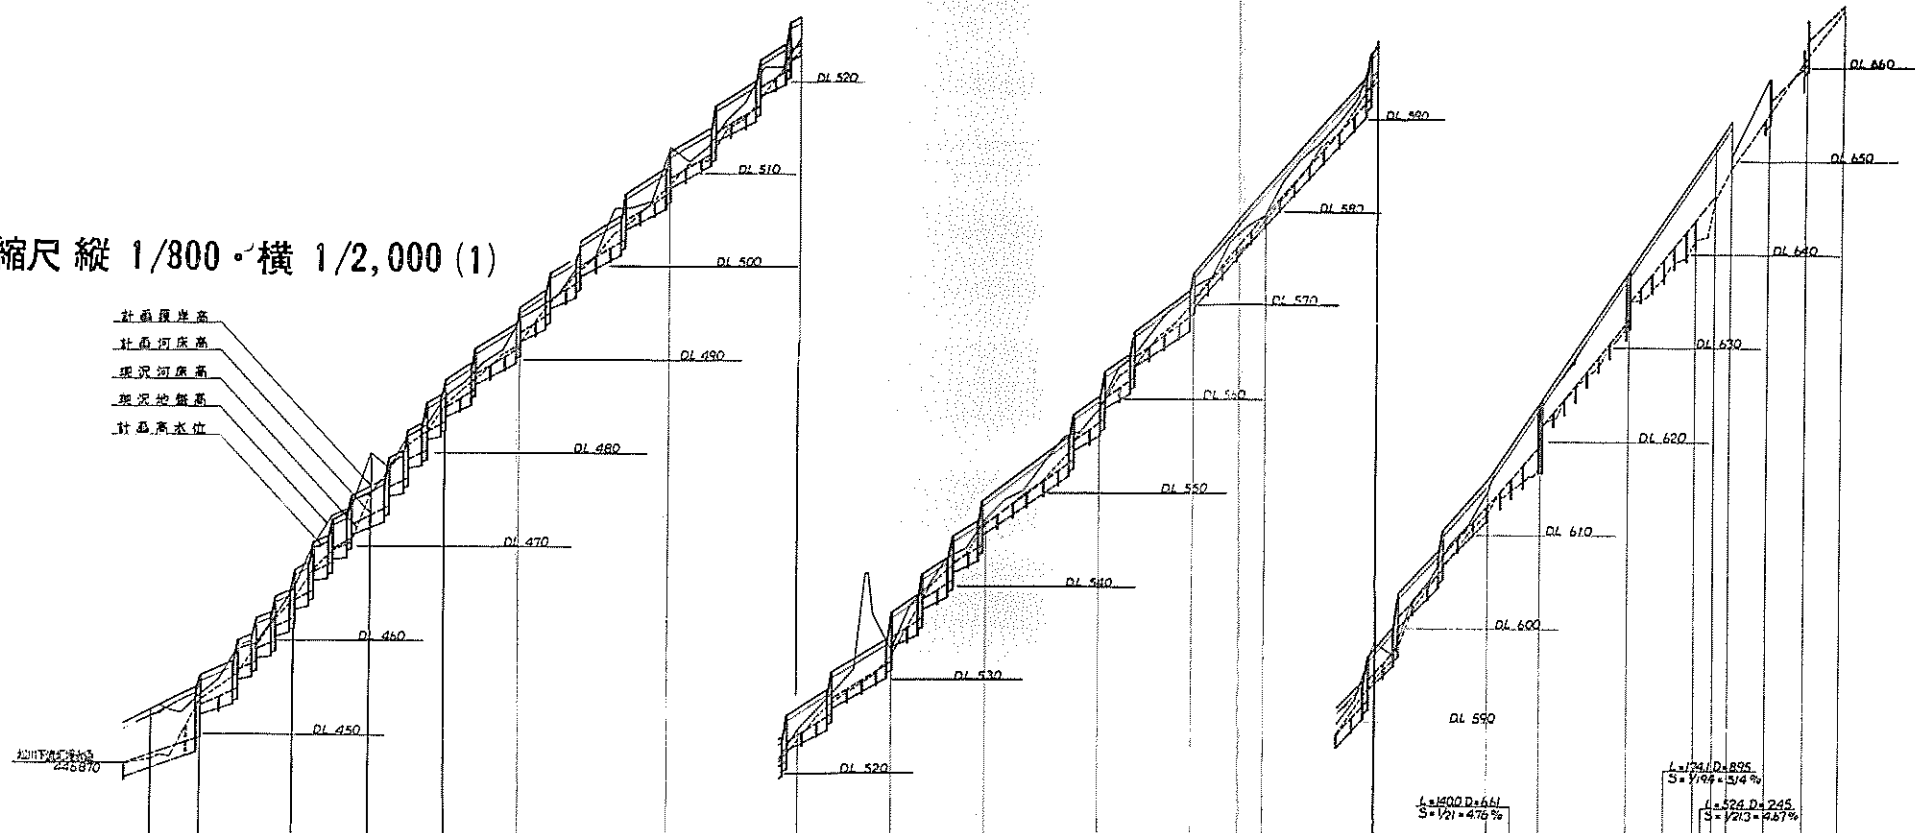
野底川纵断面图 缩尺纵 1/800 · 横 1/2,000 (1)
